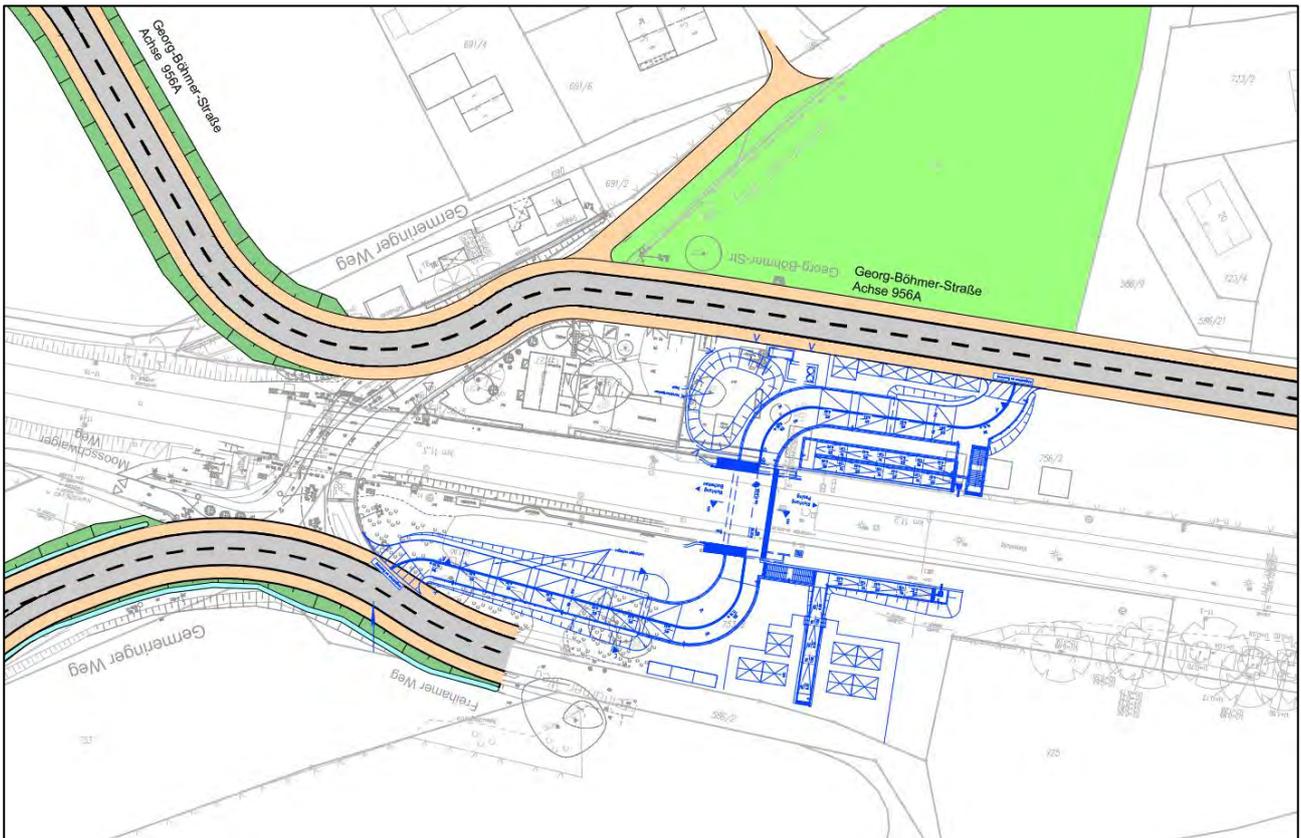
Lageplan Georg-Böhmer-Straße West
